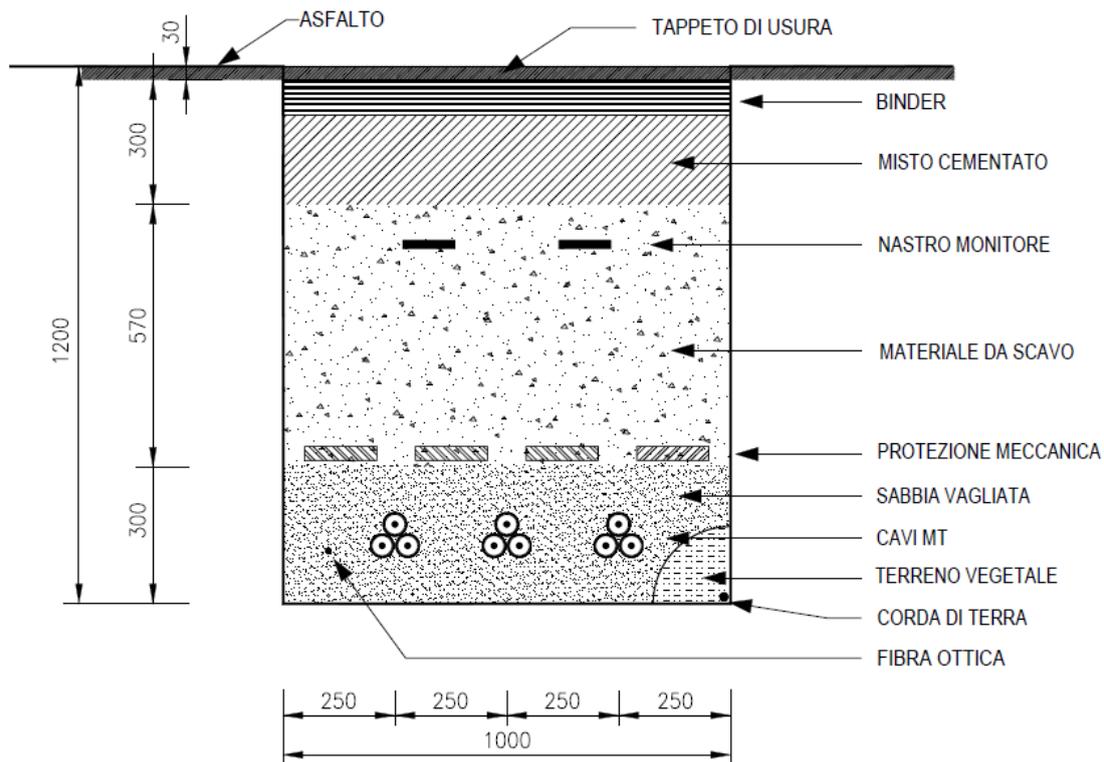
Sezione tipica di posa della linea in cavo su sede stradale
